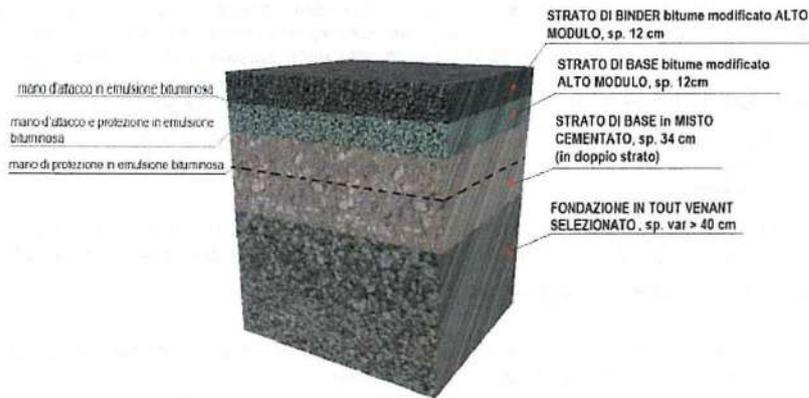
Schema stratigrafico della pavimentazione tipo 2: SEMI-RIGIDA (stacking area).
